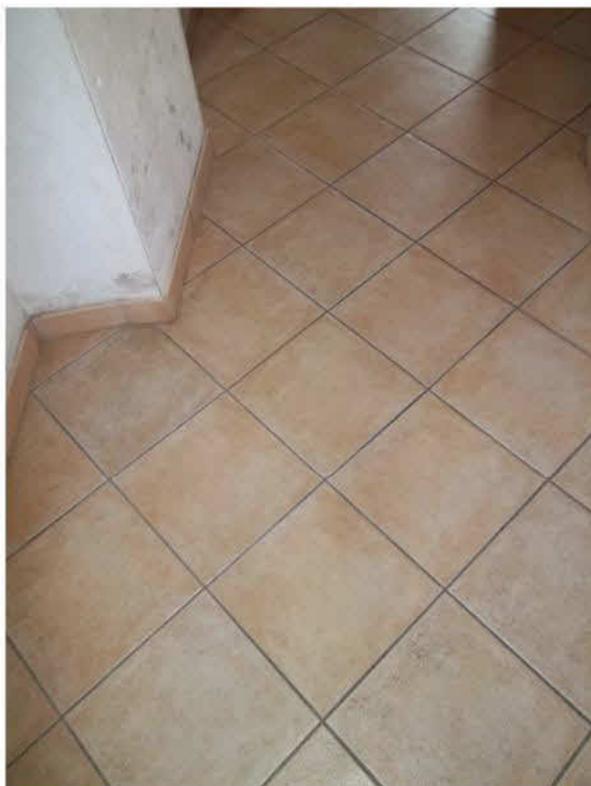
Dettaglio pavimentazione interna – Ingresso
